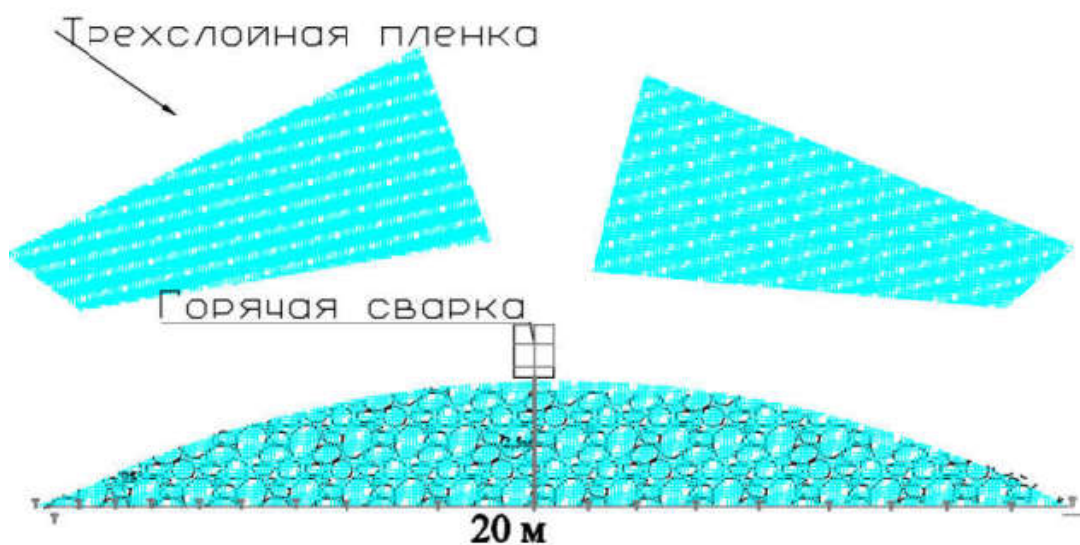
Схема покрытия штабеля угля трехслойной пленкой при формировании
